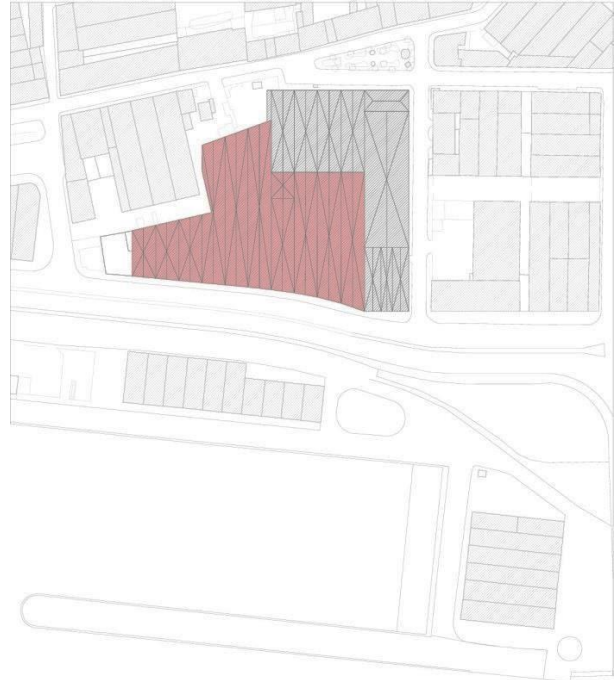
Reconstituição da planta de 1942, segundo anexo IV.
